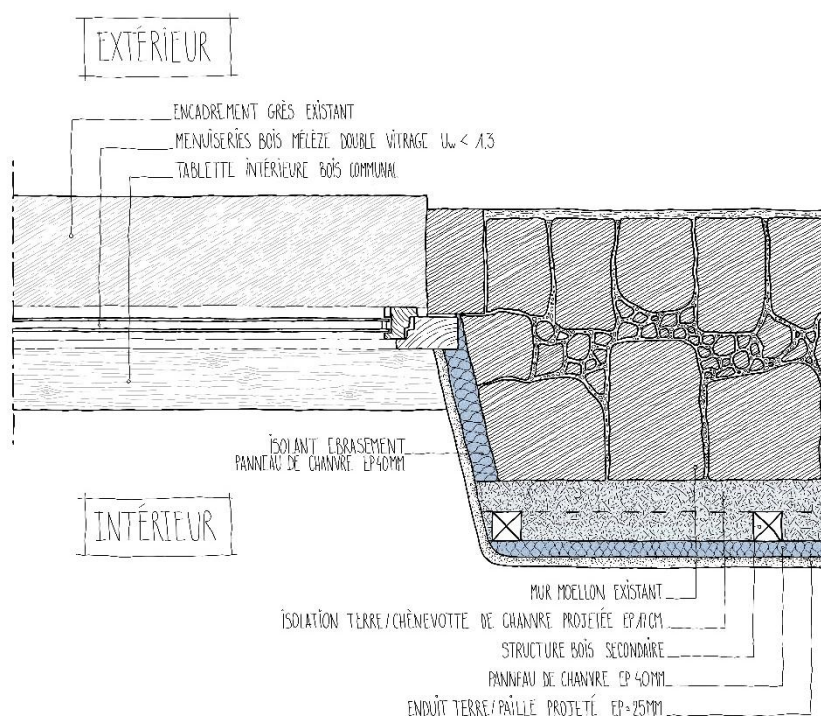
Croquis du plan de châssis courant (source Mayker Architectes)
